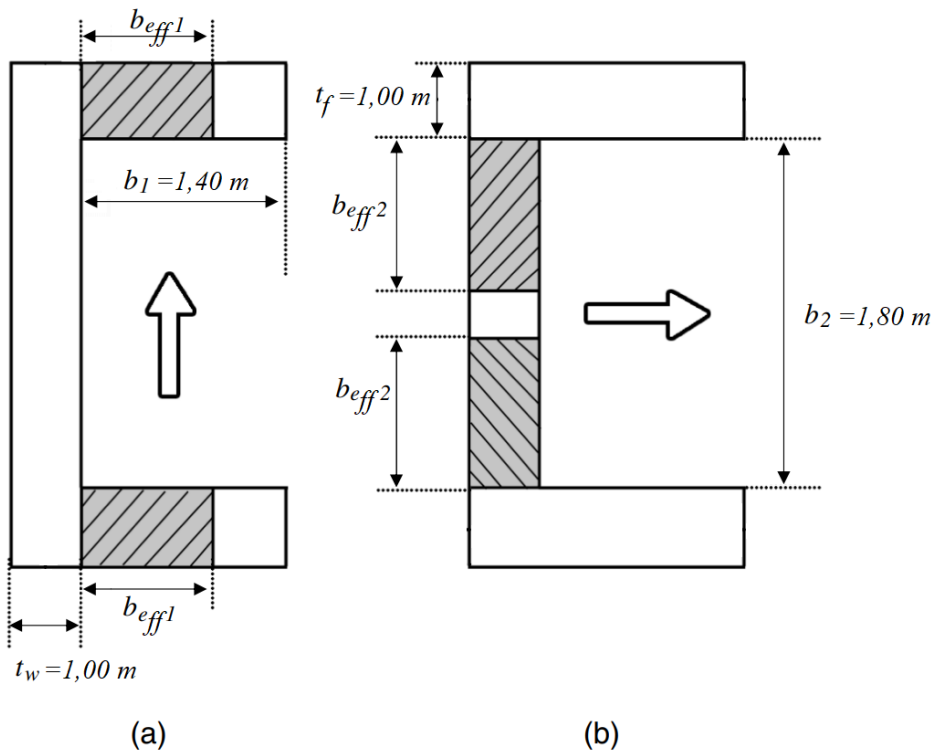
Geometría de muro en C, con ancho efectivo de las alas (b_{eff1}) y alma (b_{eff2}).
